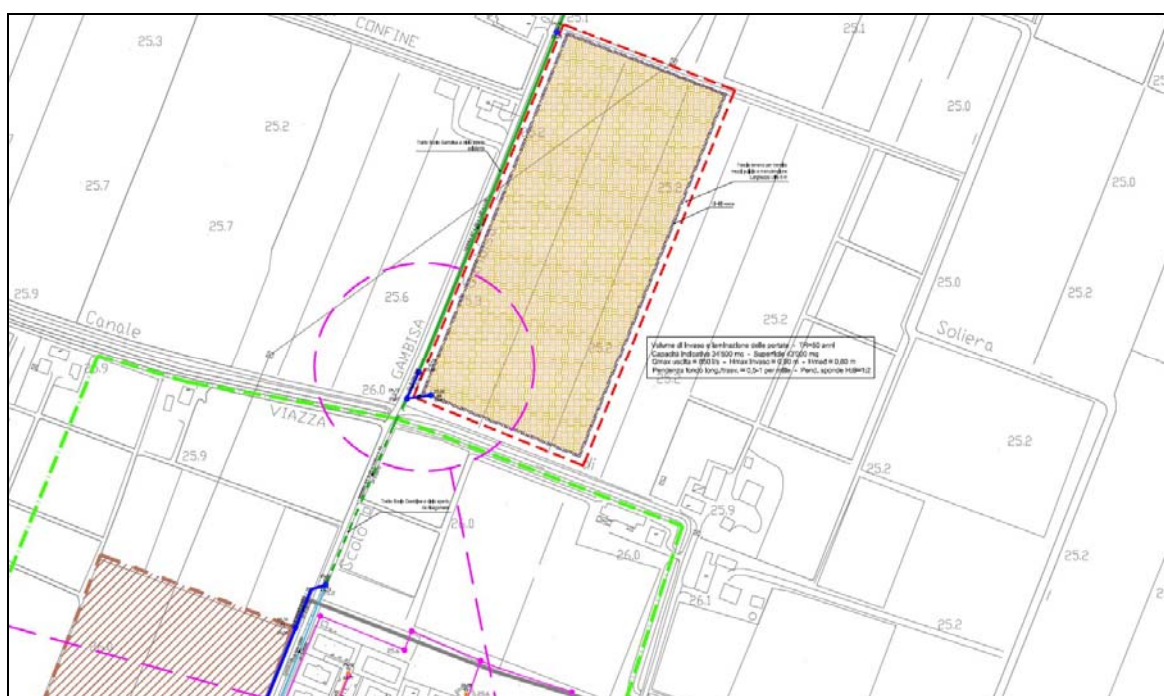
Stralcio planimetrico su base C.T.R. dell'ubicazione della vasca di laminazione in progetto.
